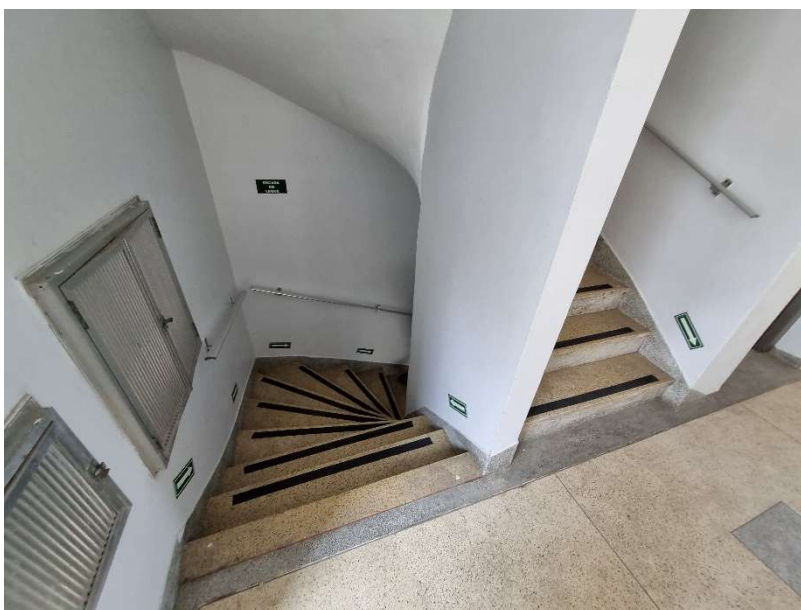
Vista da escadaria de acesso entre pavimentos do bloco Mandarin.
